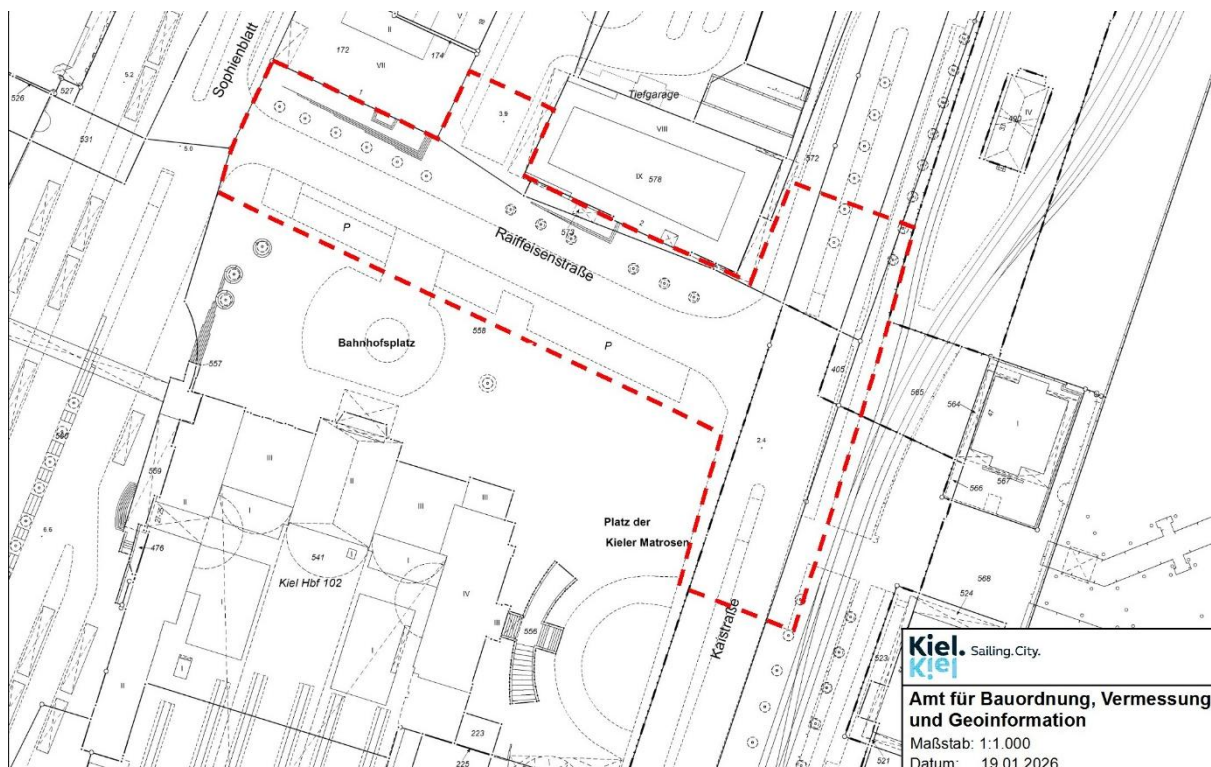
Planungsumgriff Raiffeisenstraße inkl. Knotenanschluss Kaistraße
